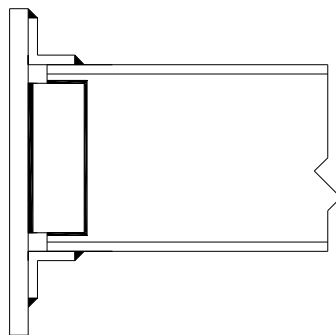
Conexiones usadas en estructuras metálicas de edificios
